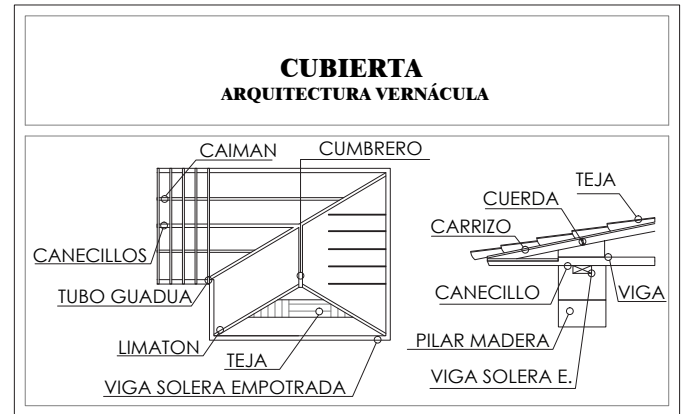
Armado y montaje de cubierta en la arquitectura vernácula.
